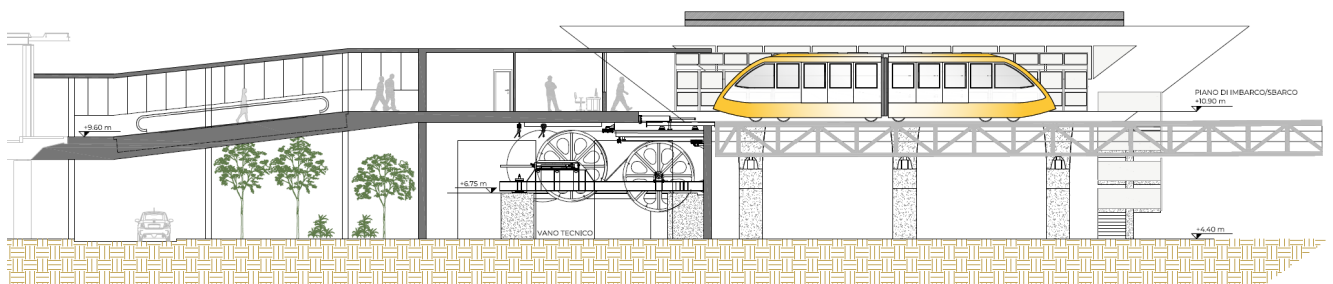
Sezione in asse impianto - stazione "Aeroporto"
